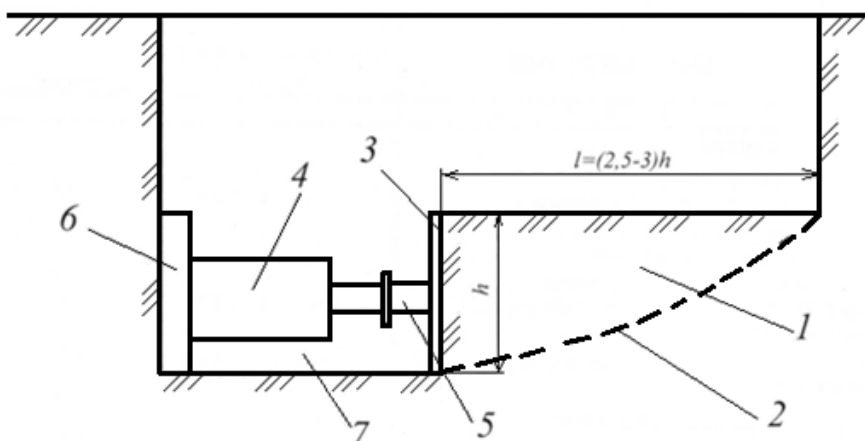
Схема установки для испытания целиков грунта на сдвиг методом выпирания:
